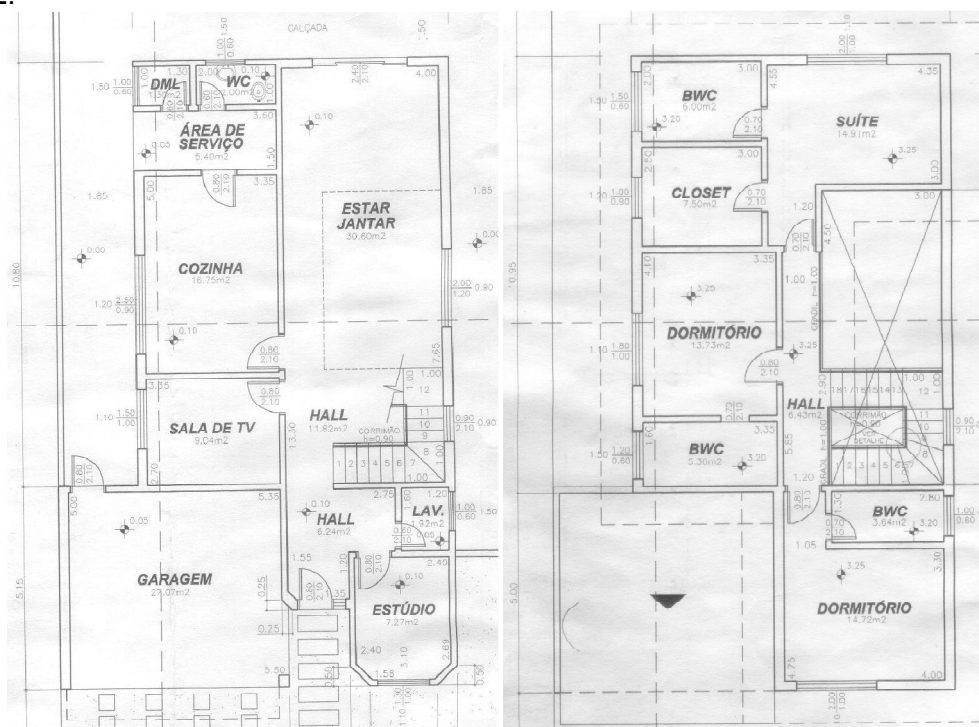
Planta Arquitetônica do Primeiro e segundo Pavimento.
